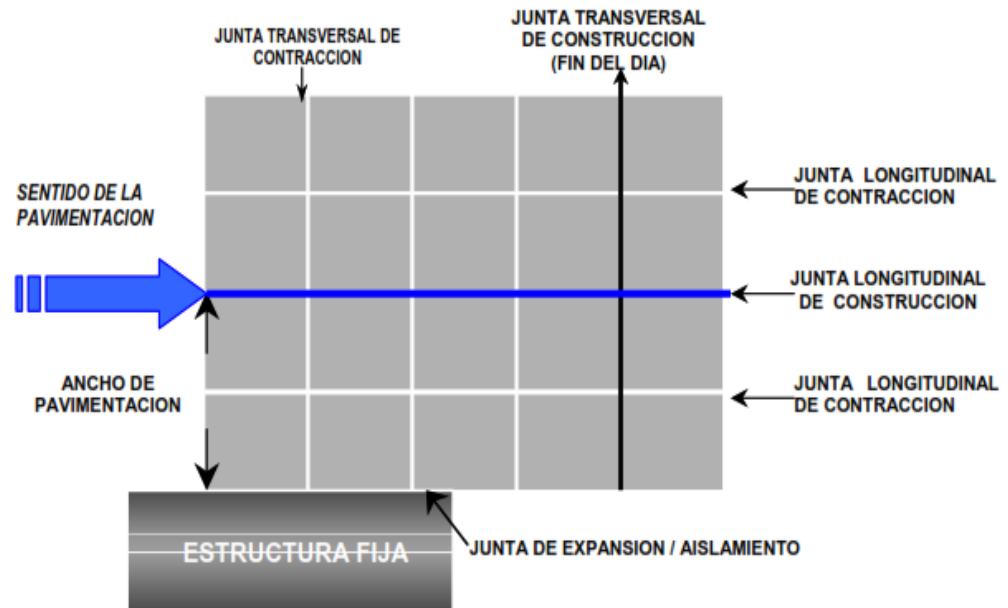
Tipos de juntas de un pavimento de concreto
